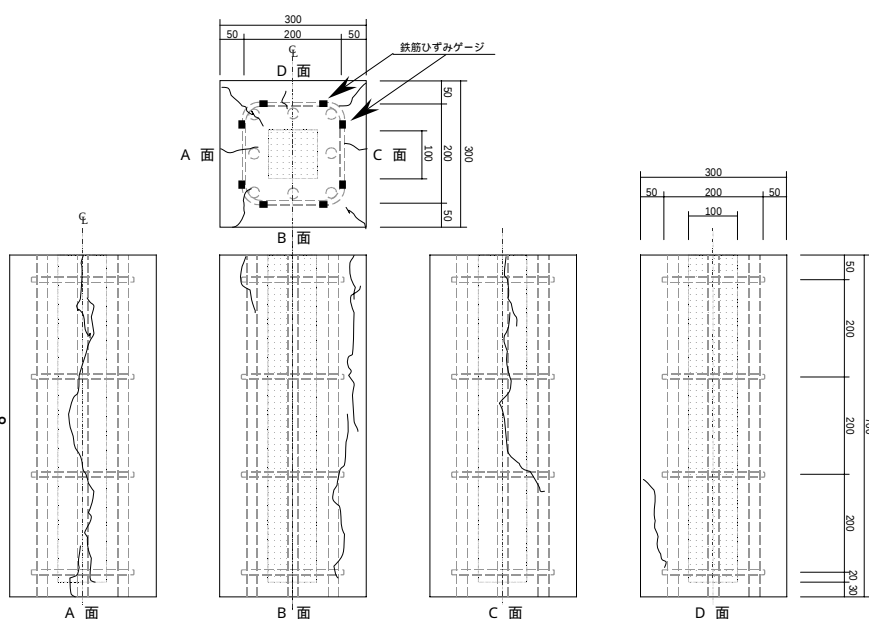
供試体形状およびひび割れ発生状況（正方形）
